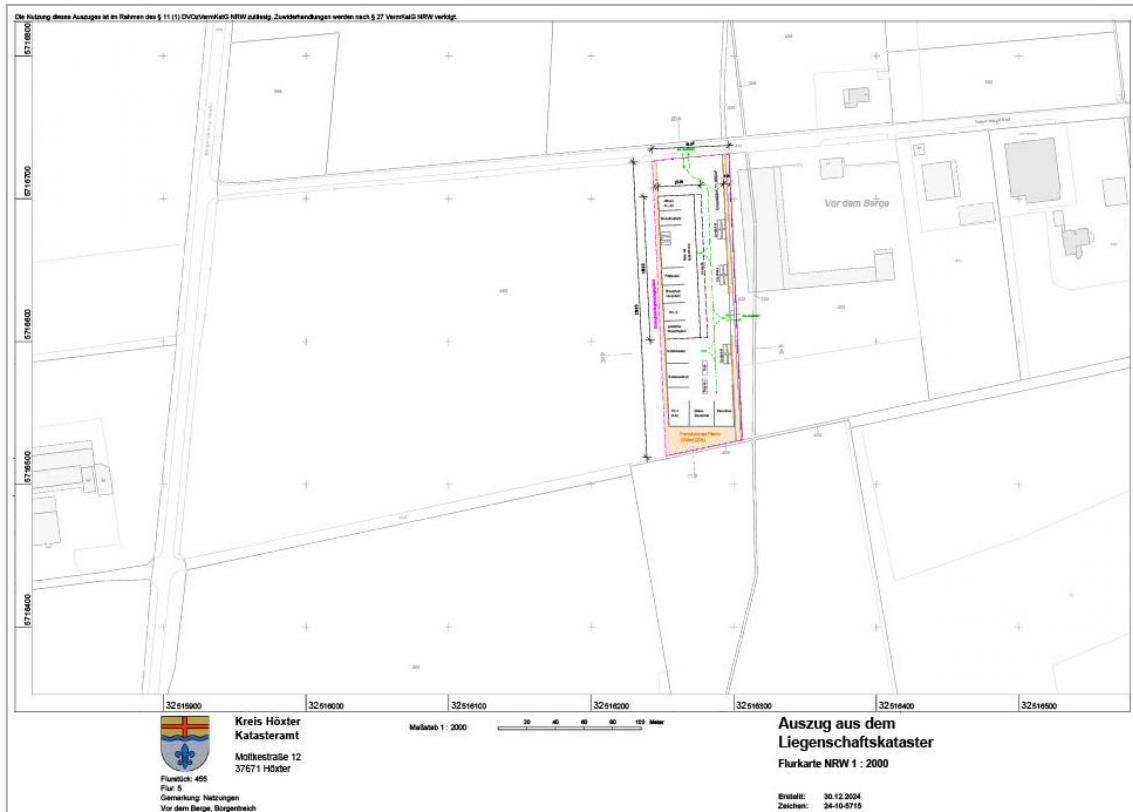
Lageplan des Grundstücks mit der vorhergesehenen Erweiterung
